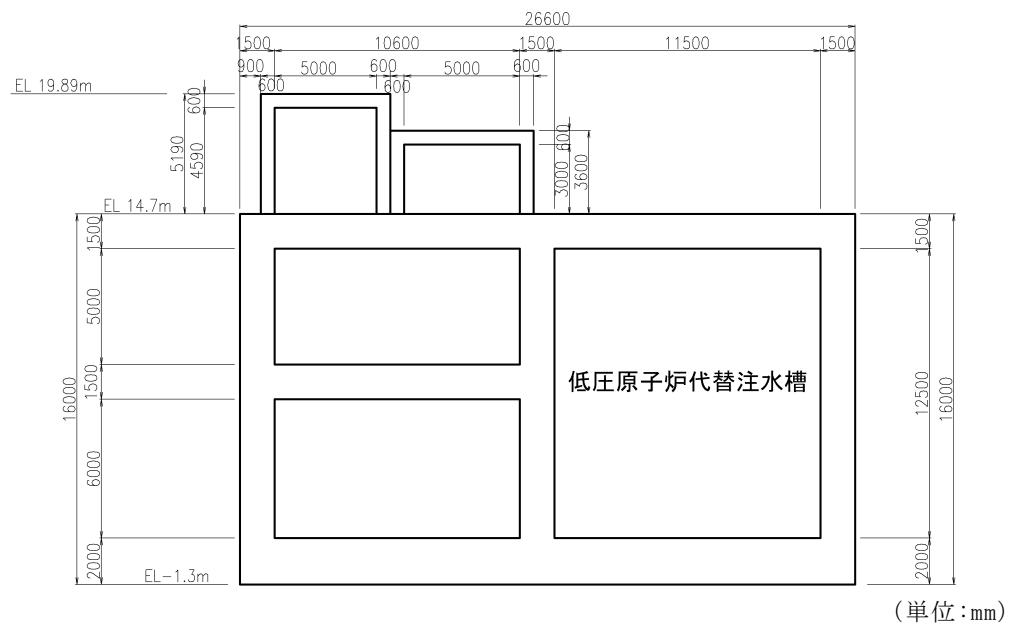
低圧原子炉代替注水ポンプ格納槽 断面図 (C-C断面)
